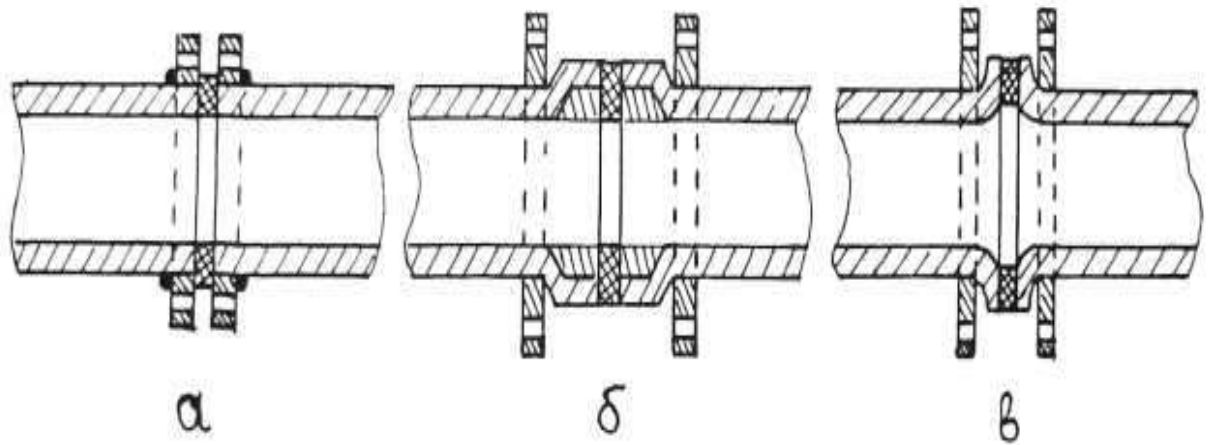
Разъемное соединение пластмассовых труб: а) соединение с приварными фланцами; б) со свободными фланцами; в) со свободным раструбами на разболтовке.
